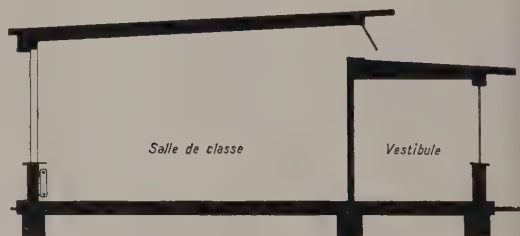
Coupe d'une salle de classe à ventilation transversale (construction en pavillons).
